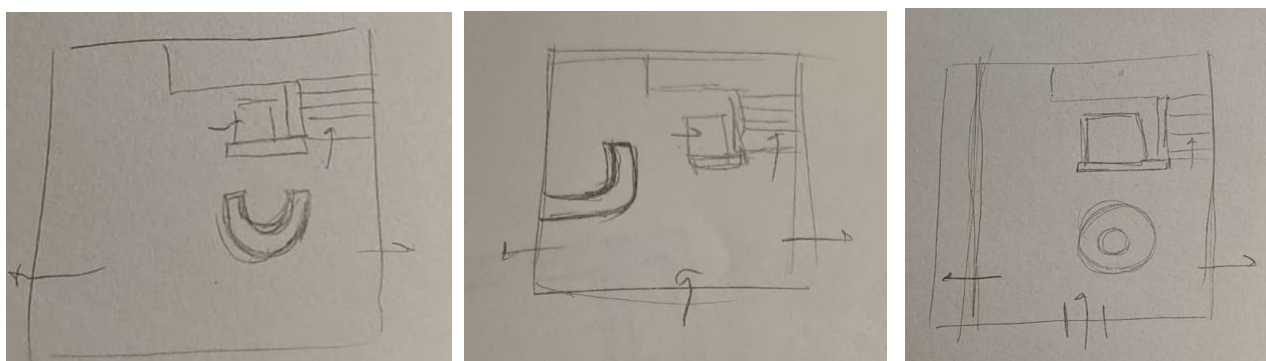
Estudo dos Layouts do Piso 0 Recepção - Fonte: Bruna Monteiro
